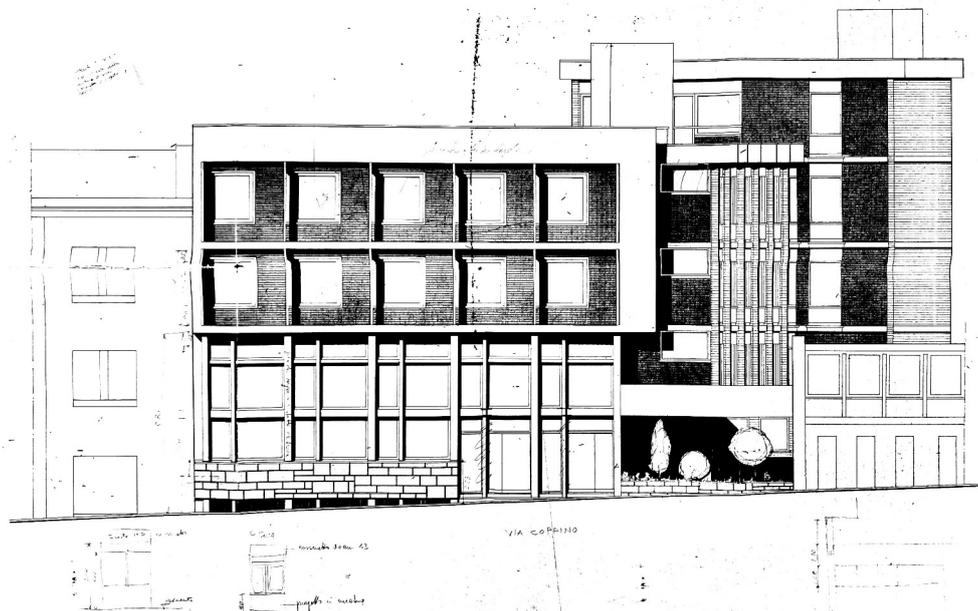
Tavola di progetto "Palazzo della Questura – Prospetto sud est"
